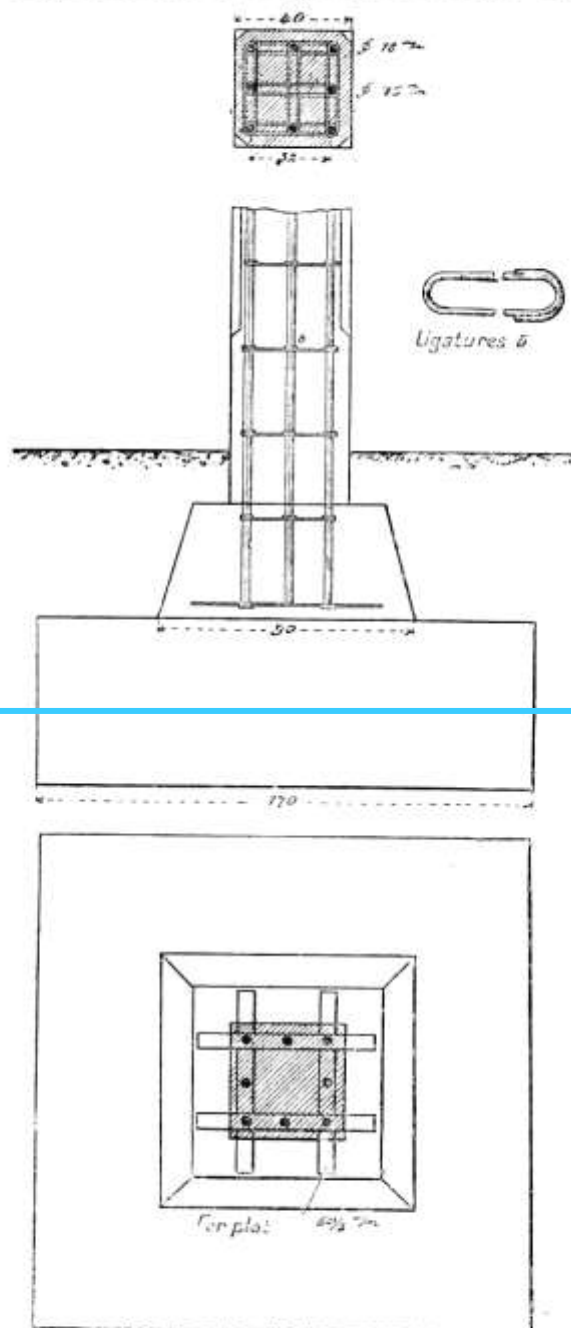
Socle et section transversale d'un pilier en béton armé.
